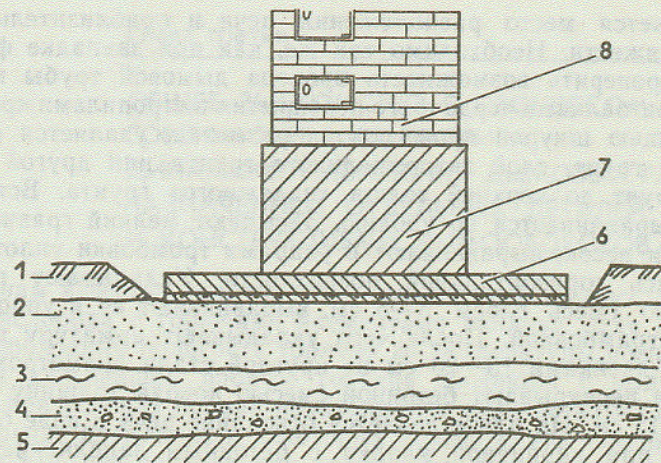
Устройство фундамента с минимальной глубиной заложения: 1 — растительный слой, 2 — слой верхнего «надежного» грунта, 3—4 — подстилающие слои «слабого» грунта, 5 — «надежный» грунт, 6 — железобетонная плита, 7 — основание печи, 8 — печная кладка.
